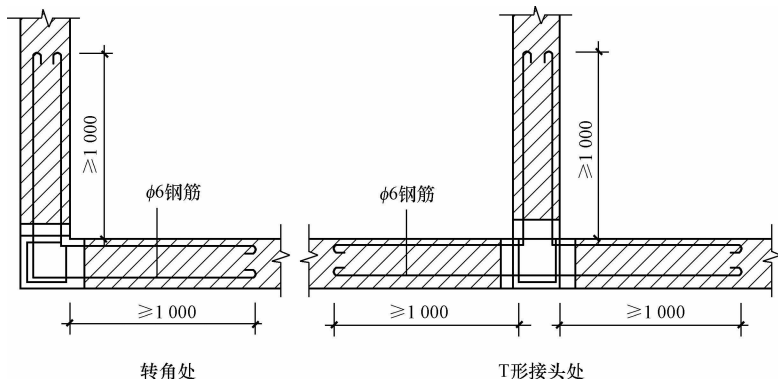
一砖墙转角处及交接处构造柱水平拉结钢筋布置
